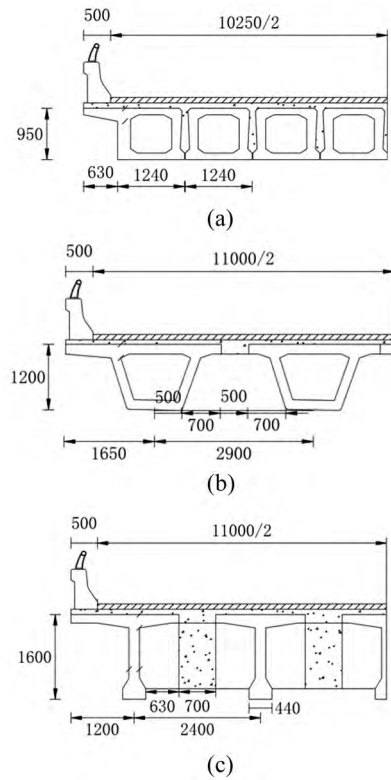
桥梁跨中 1/2 横断面图(单位: mm)
